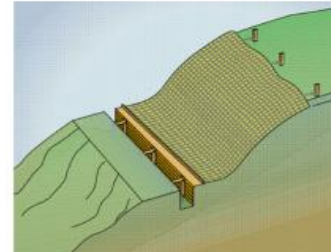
Escavação mista - com paredes em tabuletas e com paredes protegidas por cortinas
